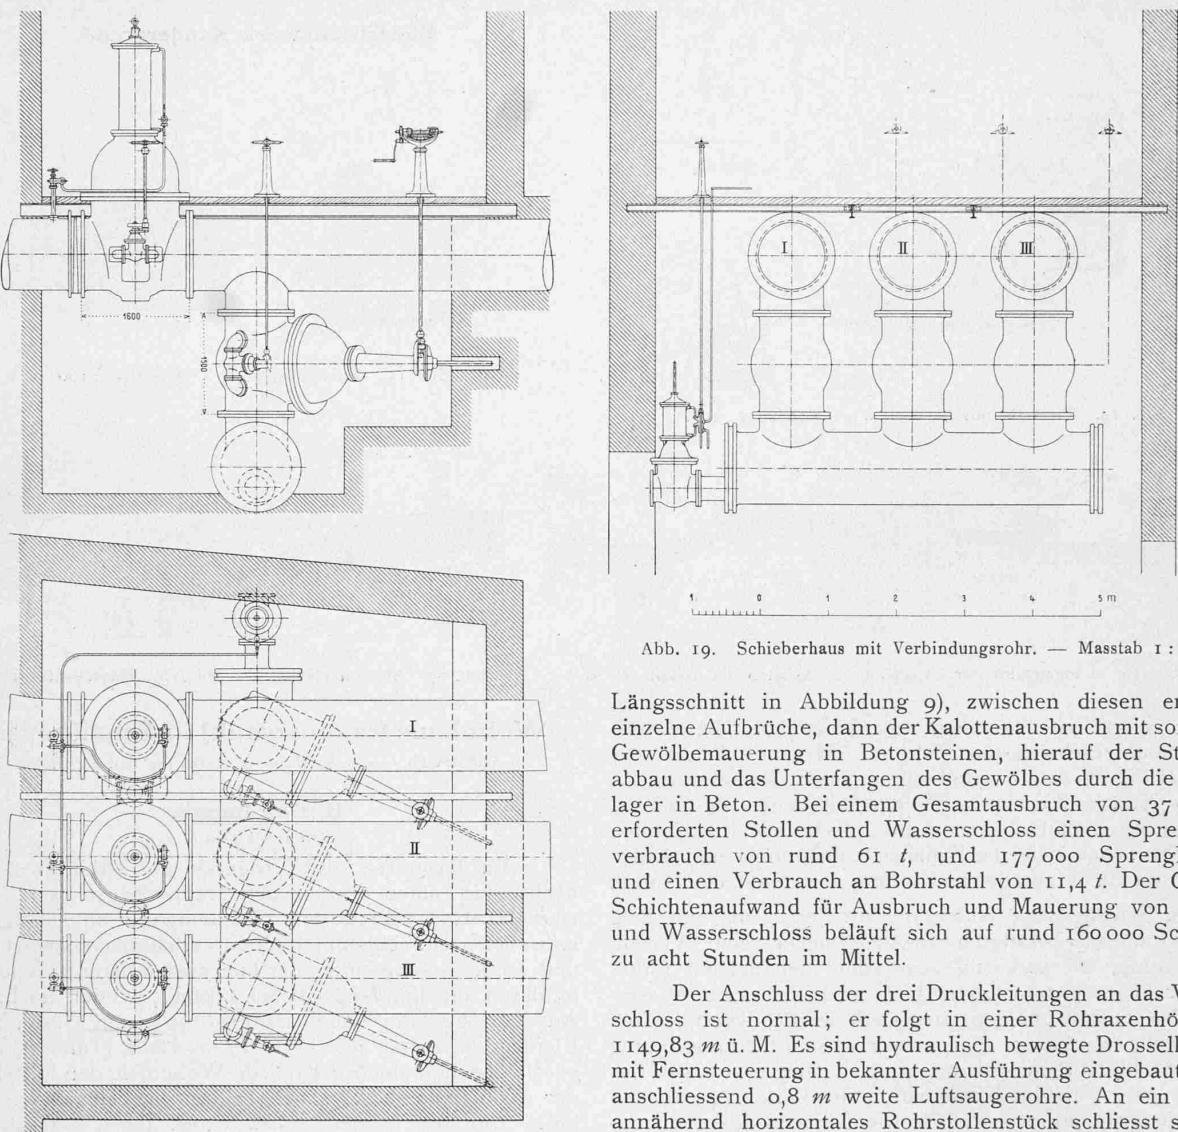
Schieberhaus mit Verbindungsrohr. — Masstab 1:100.
